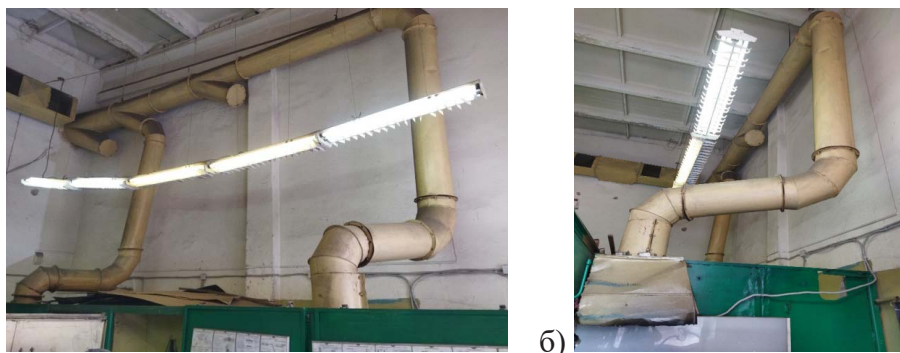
Внешний вид вентиляционной установки лаборатории для проведения сварочных работ в Ижевской ГСХА:
